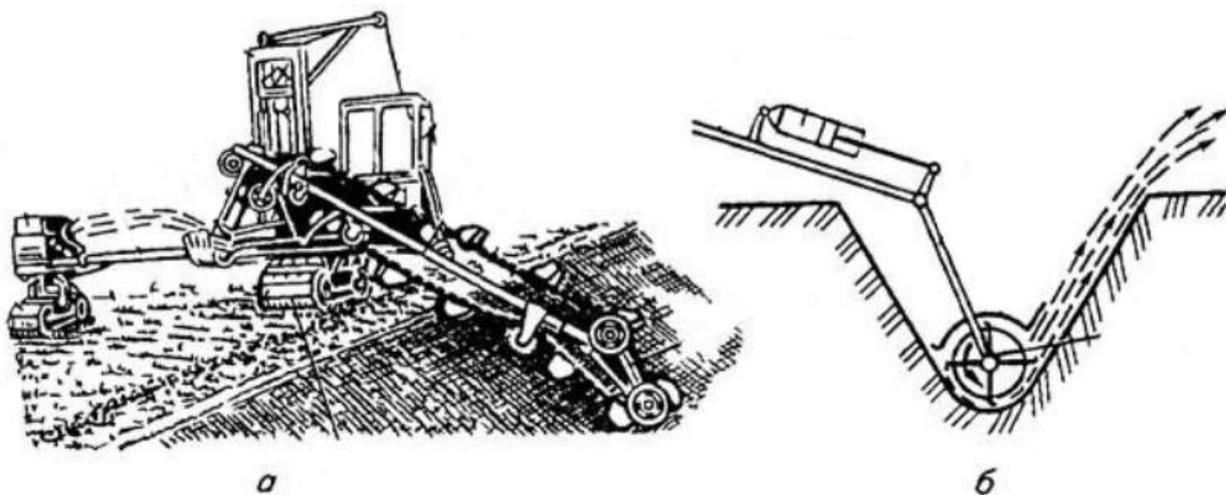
Каналоочиститель ЭМ-202: а – схема рабочего процесса; б – роторный рабочий орган
